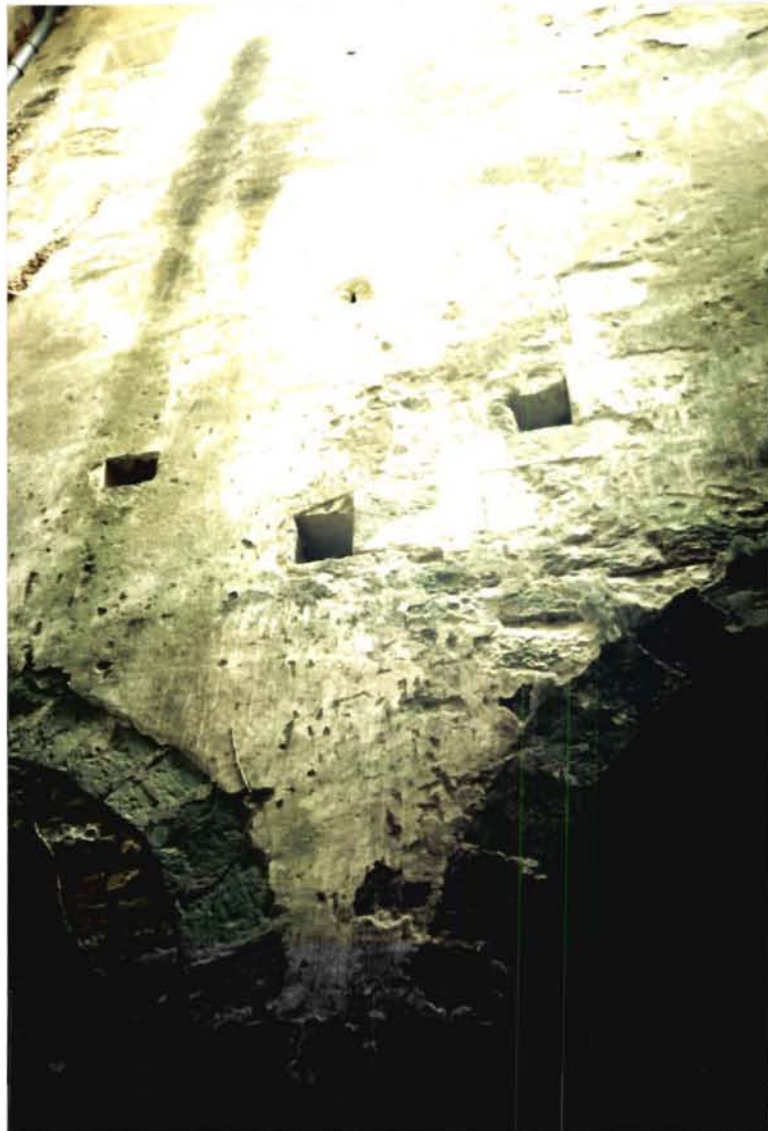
Corps A. Rez-de-chaussée : colonne centrale
